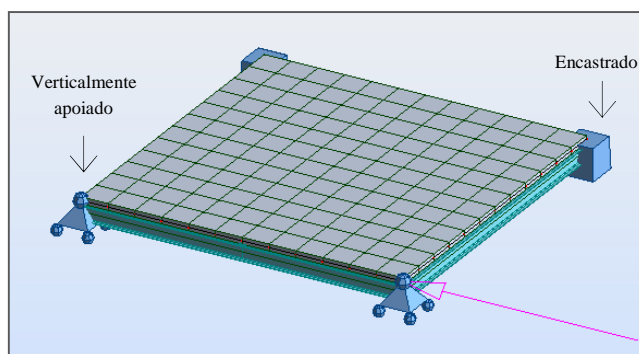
Modelo I: determinação da rigidez axial da laje mista.
